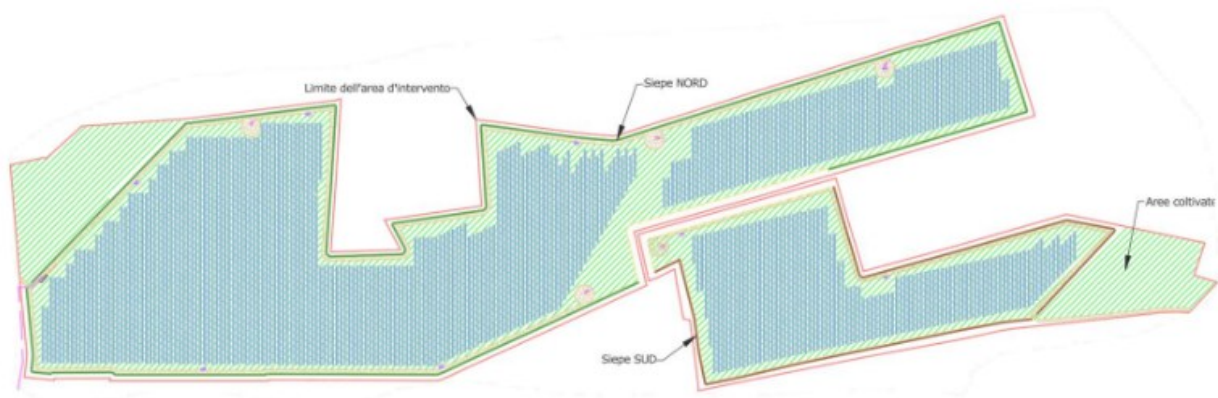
Planimetria generale con andamento delle siepi perimetrali
